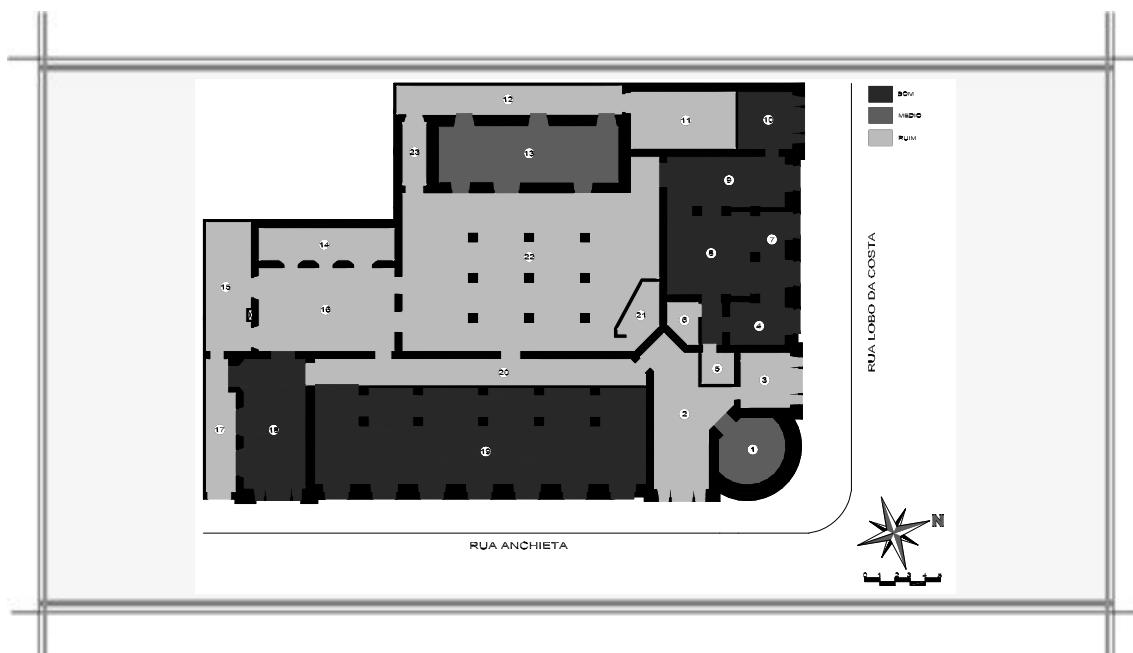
Planta Baixa do Subsolo – Estado de Conservação. Desenho: Cristiane Müller.
